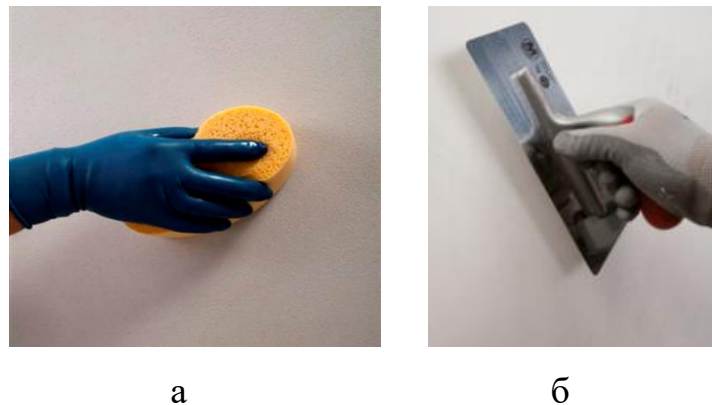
Фінішна обробка поверхні: а – губкою; б – шпателем
